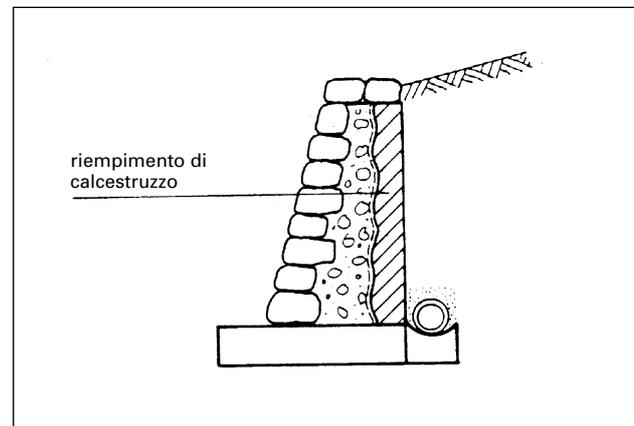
Risanamento di una muratura permanentemente intrisa d'acqua con la messa in luce, la posa di condotte di drenaggio ed il riempimento con calcestruzzo.
